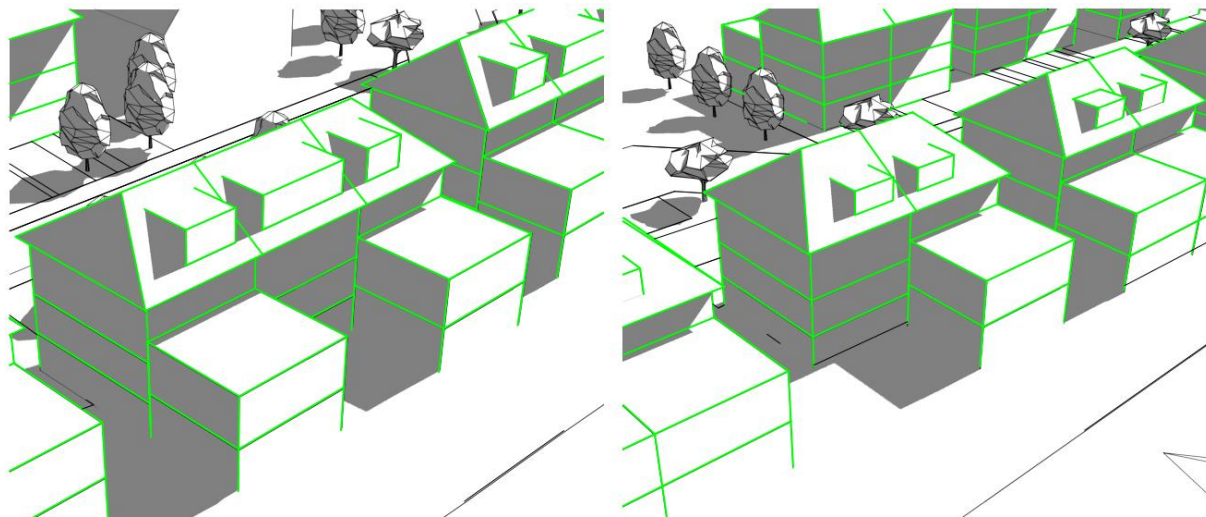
VUE D'ENSEMBLE (PROFONDEUR 16M ET HAUTEUR MAXIMALE 6M25 POUR LE VOLUME ANNEXE ET UNE LUCARNE EN FAÇADE ARRIERE)
